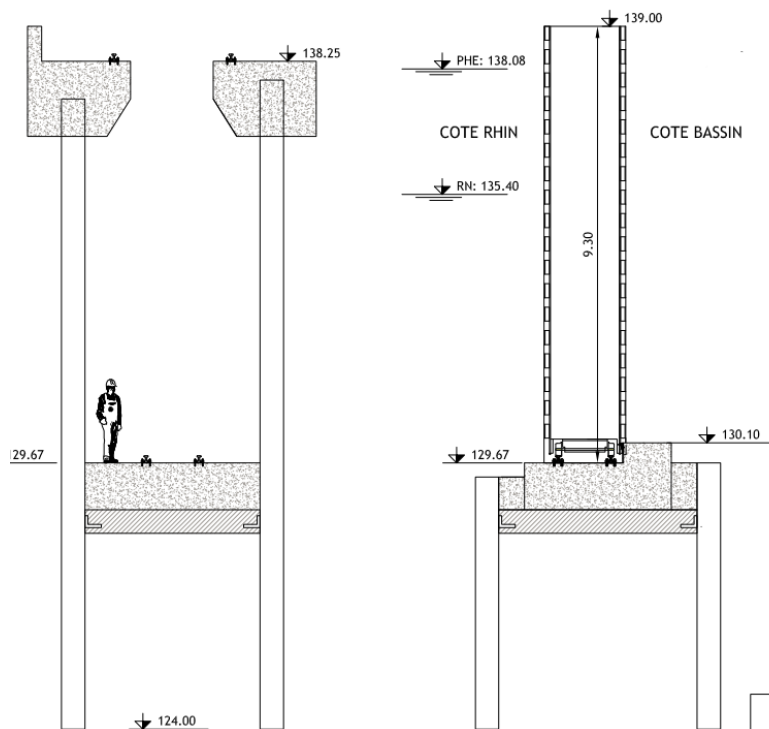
Schéma des ouvrages au niveau de la passe navigable et en stockage en rive Nord.
